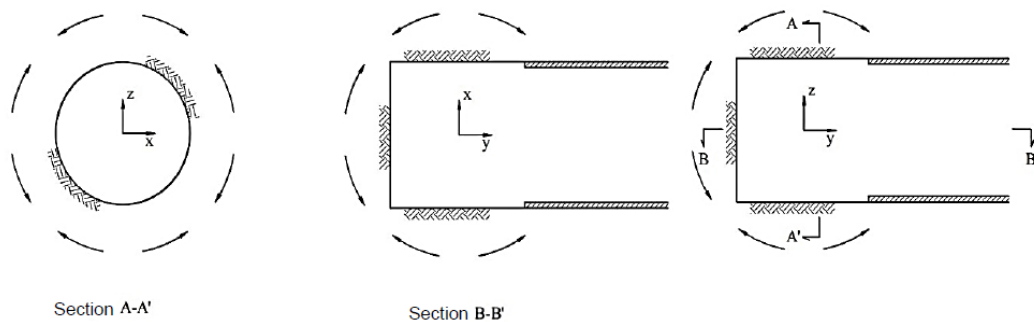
Efeito de arco tridimensional nas proximidades da frente de escavação de um túnel suportado. a) Plano longitudinal vertical; b) Plano transversal; c) Plano longitudinal horizontal [41].
